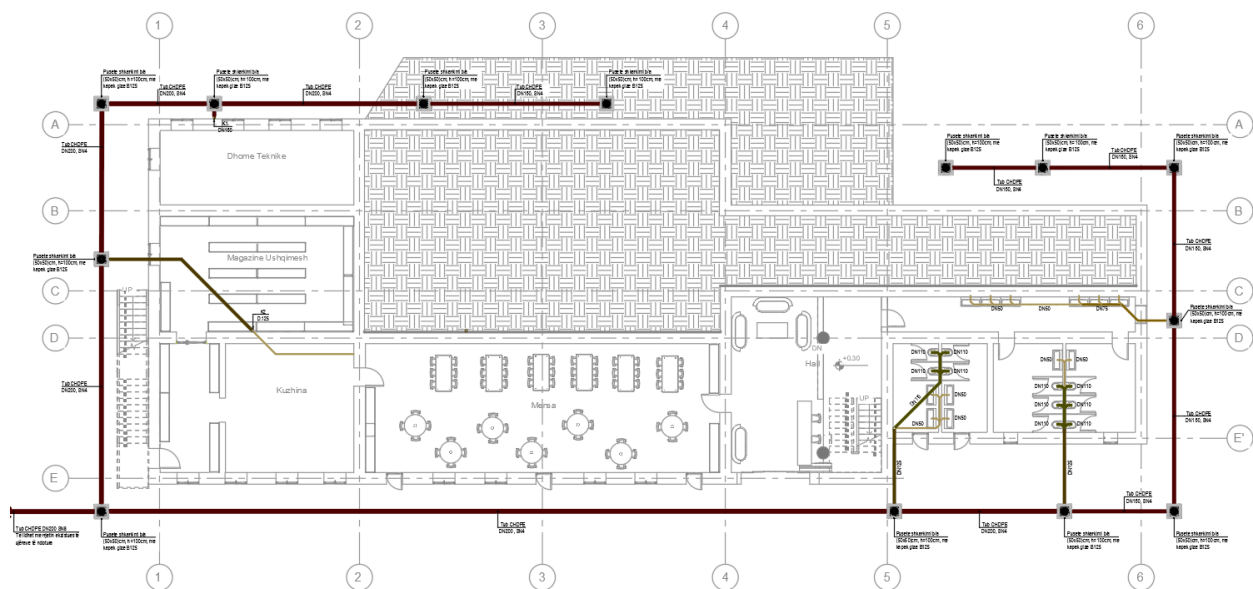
Planimetria e Shkarkimit te Ujerave te Ndotura në katin përdhe
